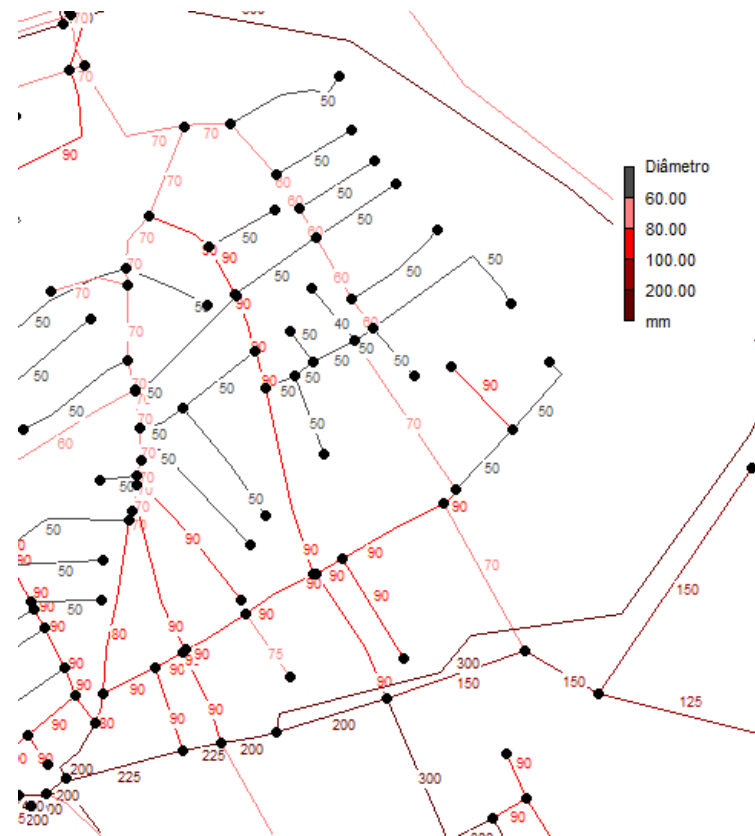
Diâmetros das condutas na zona de São Mamede.
